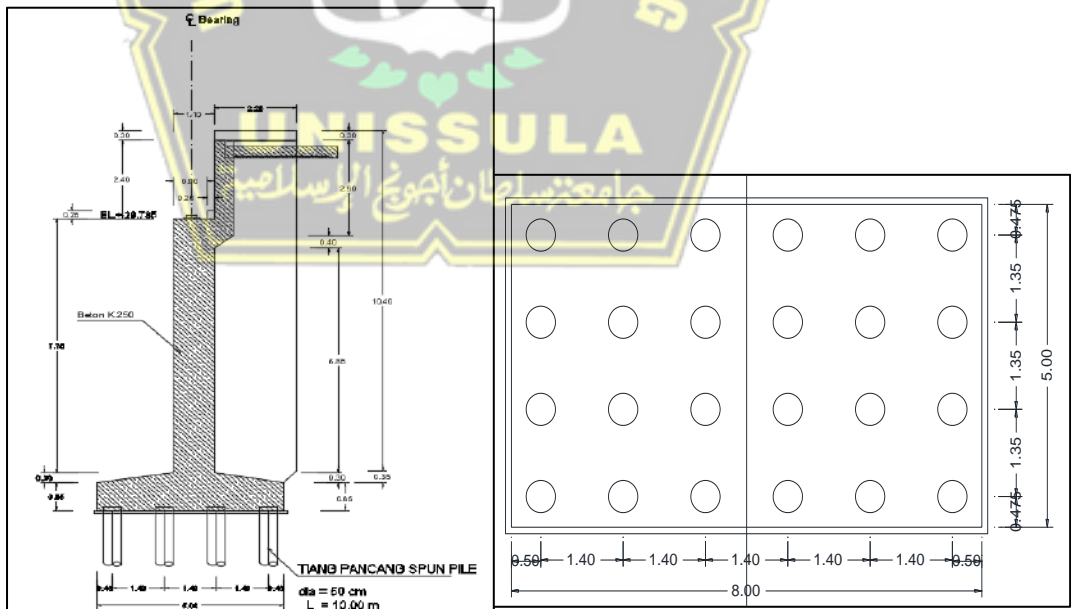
Pilar Jembatan dan Denah pondasi 30 titik (2 buah)
